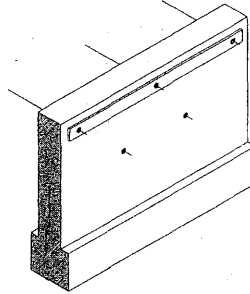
Reparación de muros de contención con nueva estructura.
